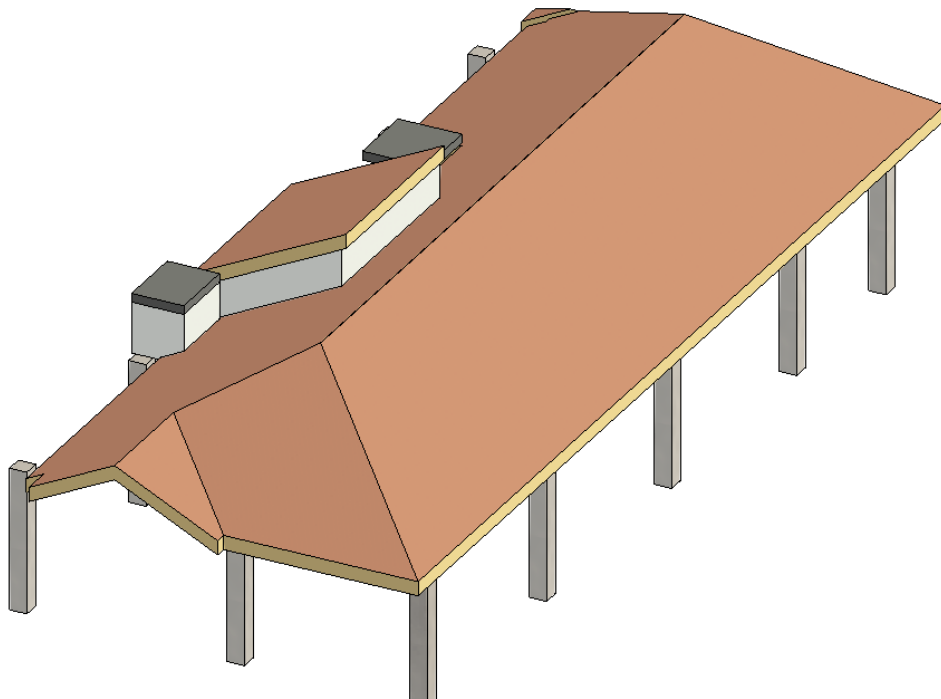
Modelo arquitectónico, 2da planta alta, vista en planta*Figura 9*Modelo arquitectónico, 2da planta alta, vista 3D
